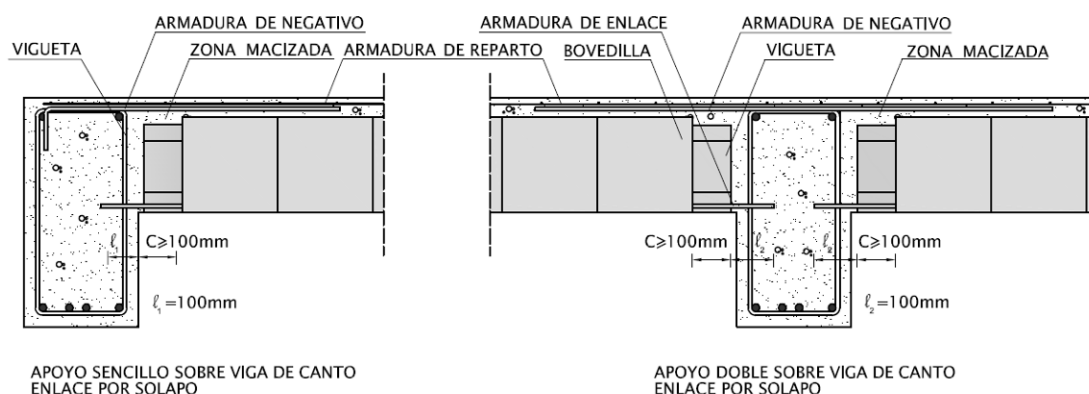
Apoyo sobre viga de canto. Enlace por solapo
